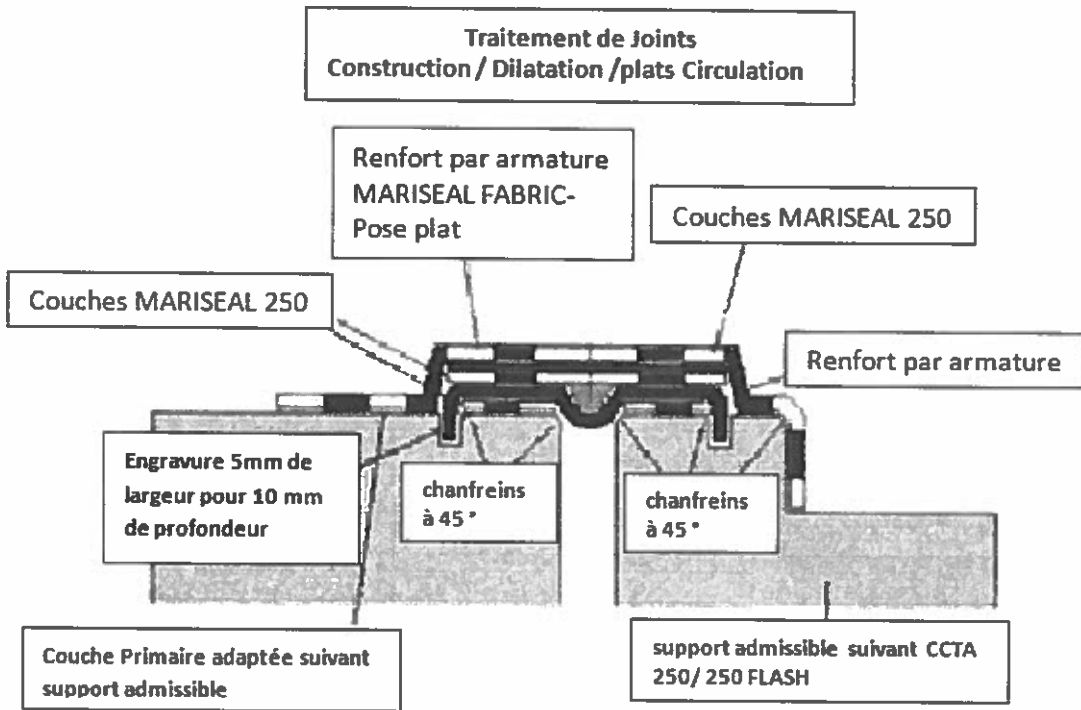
Traitement de Joints de Dilatations / Construction - Plats Circulables.
